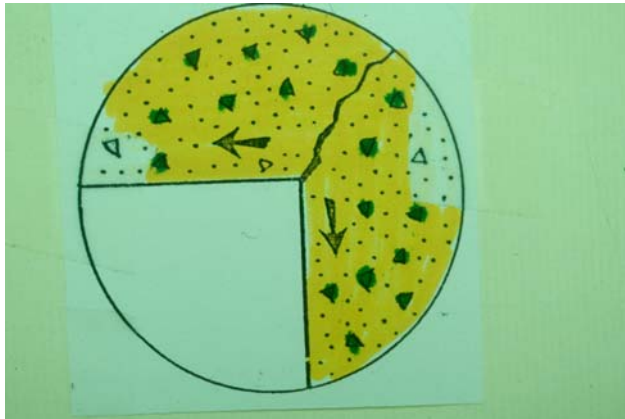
Fissura em ângulo, resultante da concentração da tensão de tração no concreto.
